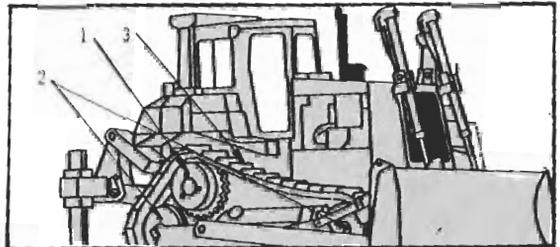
Disposición elevada de la rueda de cabilla (CAT). 1.- Rueda motriz. 2.- Ruedas guía. 3.- Cadena. 4.- Rodillo inferior de apoyo.
